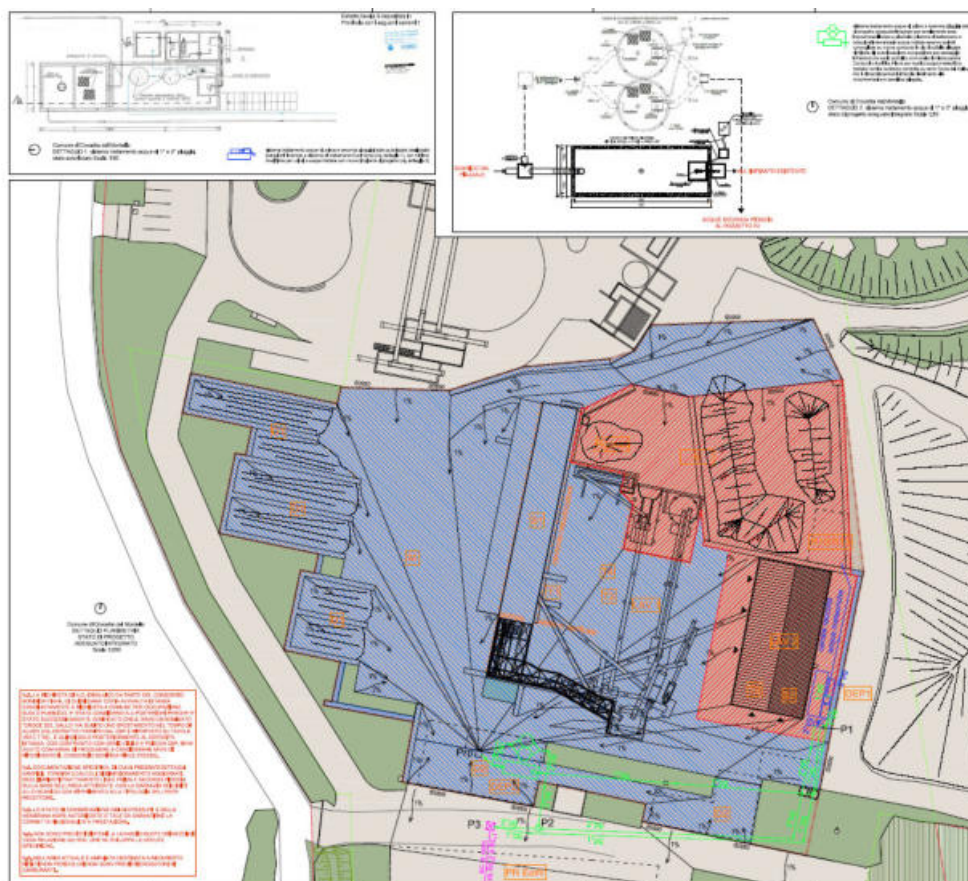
estratto planimetria S9 003_19 PAUR_Tav 09_st prog plan_tr acque_pe_2023.04.01
